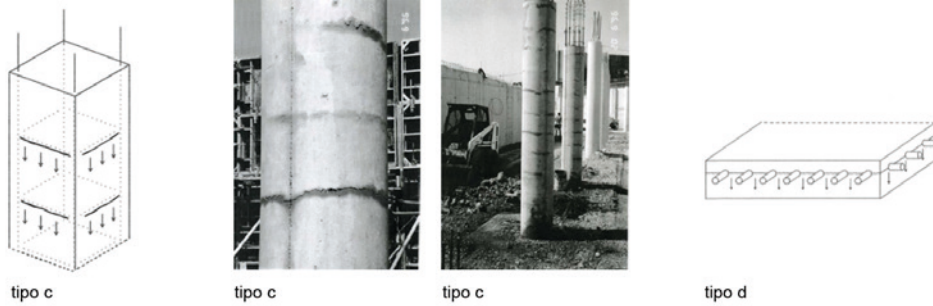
Fisuras de asentamiento plástico. Tipos c y d.
